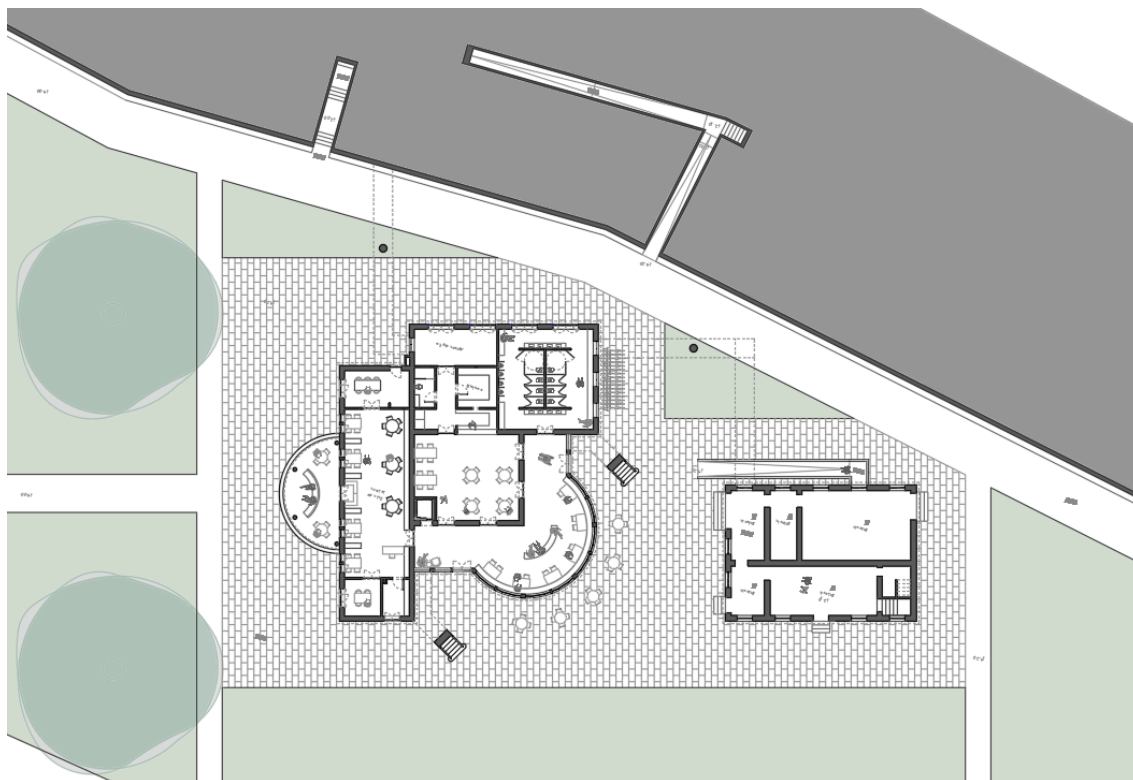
EAG - planta Piso Térreo, desenho 49 (elaborado pelo autor)
